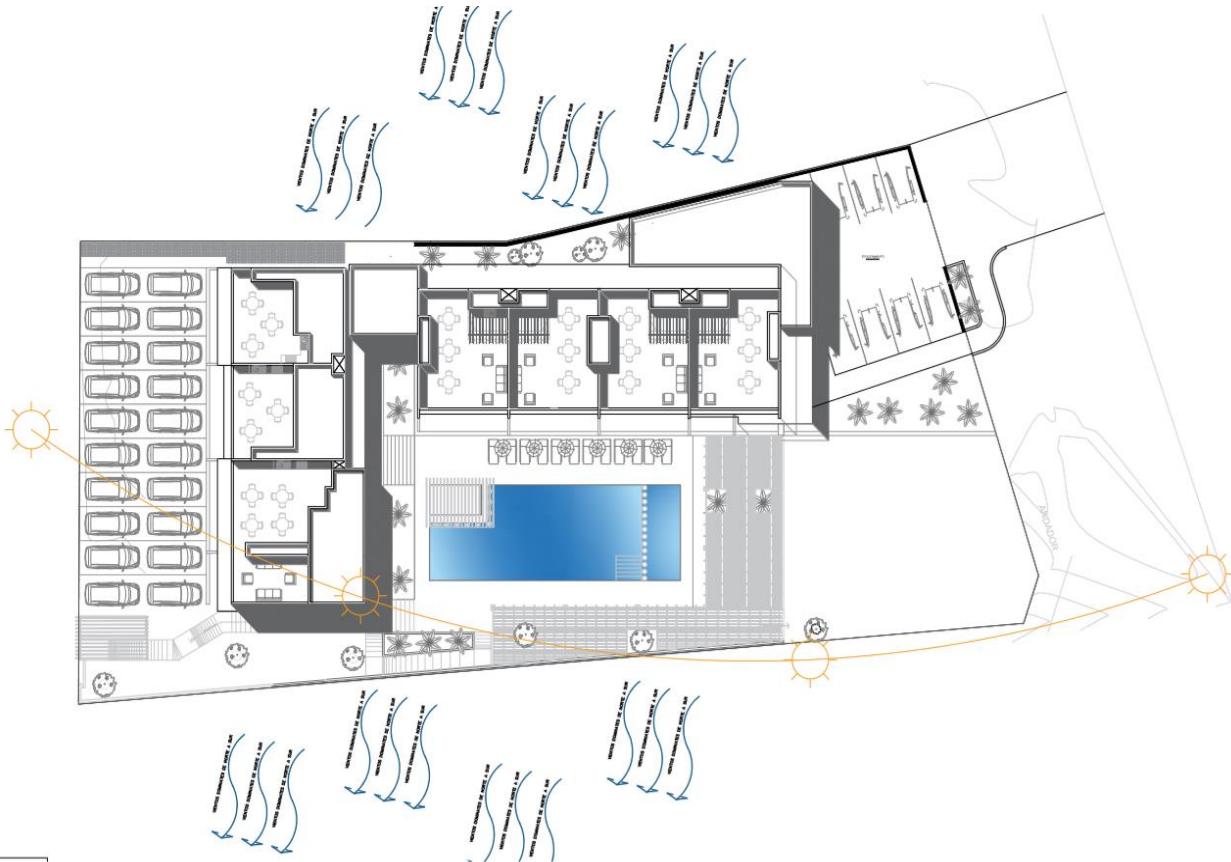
Planta arquitectónica de conjunto de los edificios residenciales.
